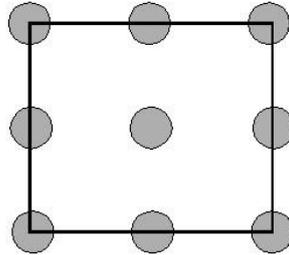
b Croquis de cimentación de zapata con columnas de jet -
